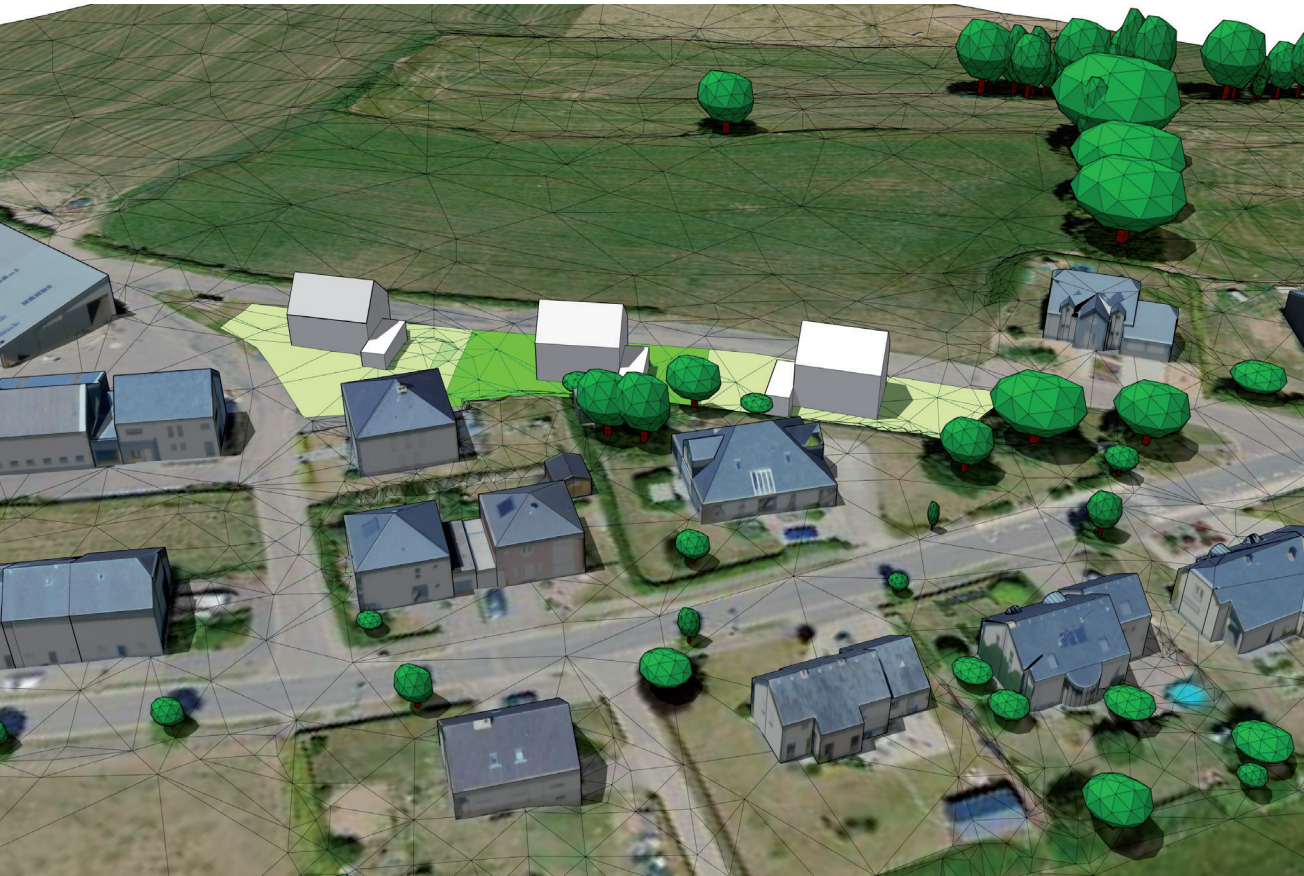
Schwarzplan: existierende Bebauung und geplante maximale Baufenster
